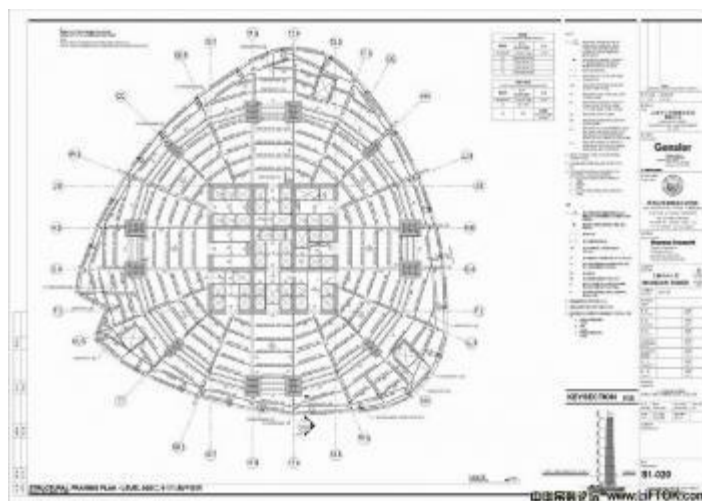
Planta Estrutural de um dos pisos da *Shanghai Tower* (Arch2O)
